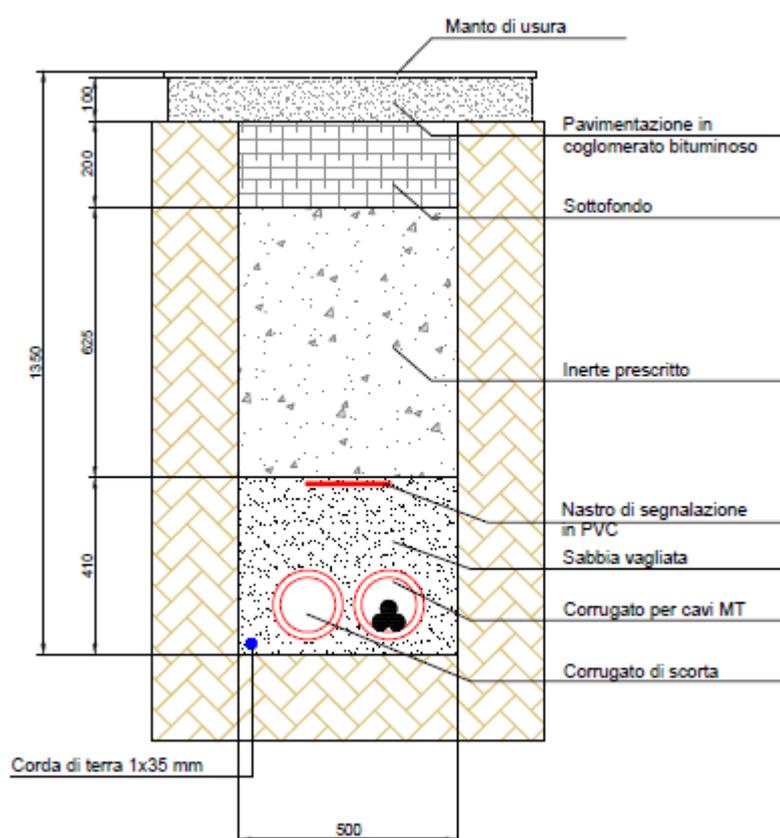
Sezione tipica di posa della linea in cavo su strada asfaltata
